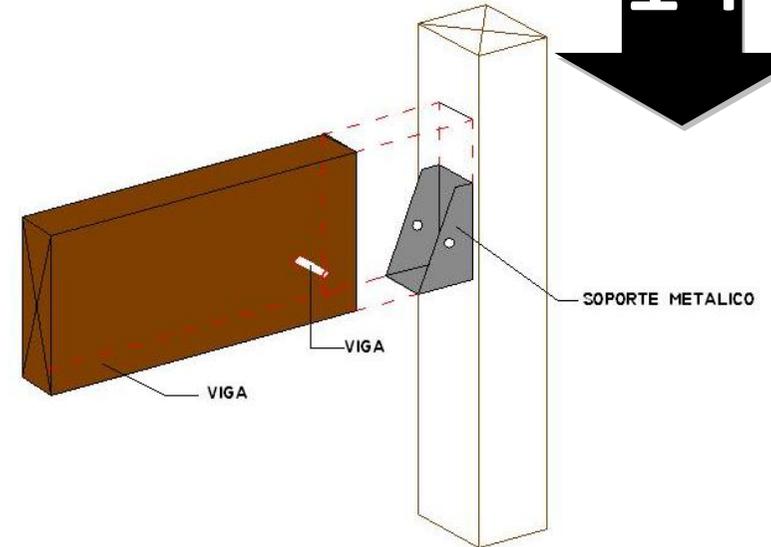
DETALLE DE UNION CON SOPORTE METALICO
